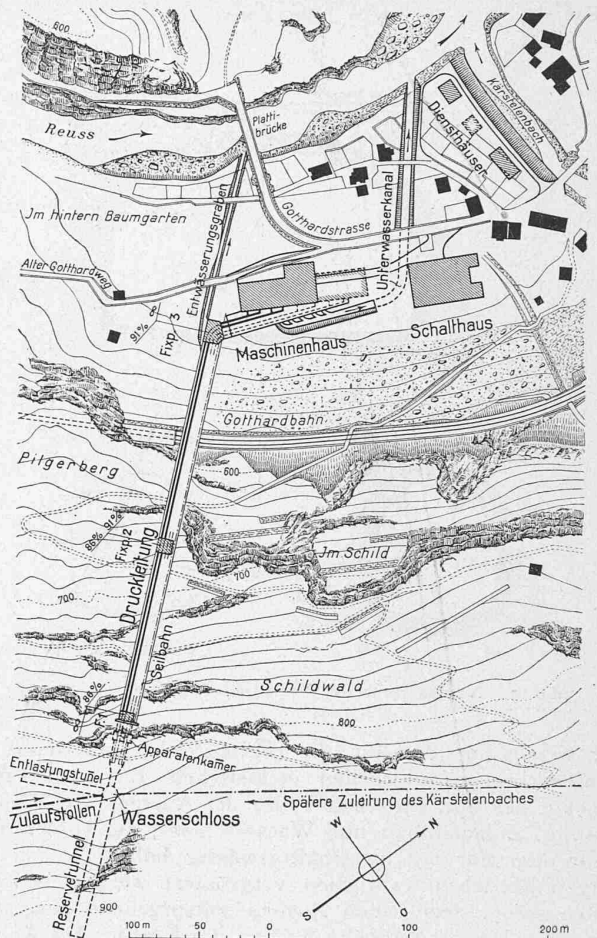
Wasserschloss, Druckleitung und Kraftwerk. Lageplan. — Masstab 1 : 5000.
